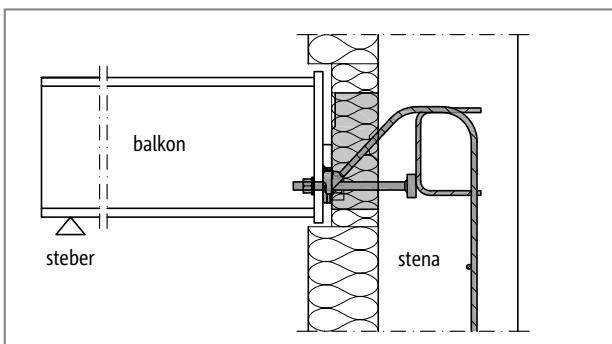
Schöck Isokorb® T tip SQP: priključek na železobetonski strop; izolacijski element v zunanjji izolaciji
